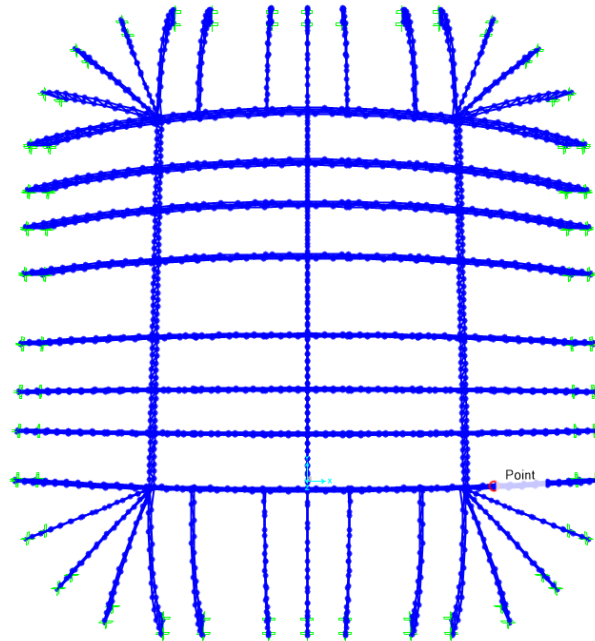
Planta del techo coliseo Iolo Fernández. Fuente propia.
